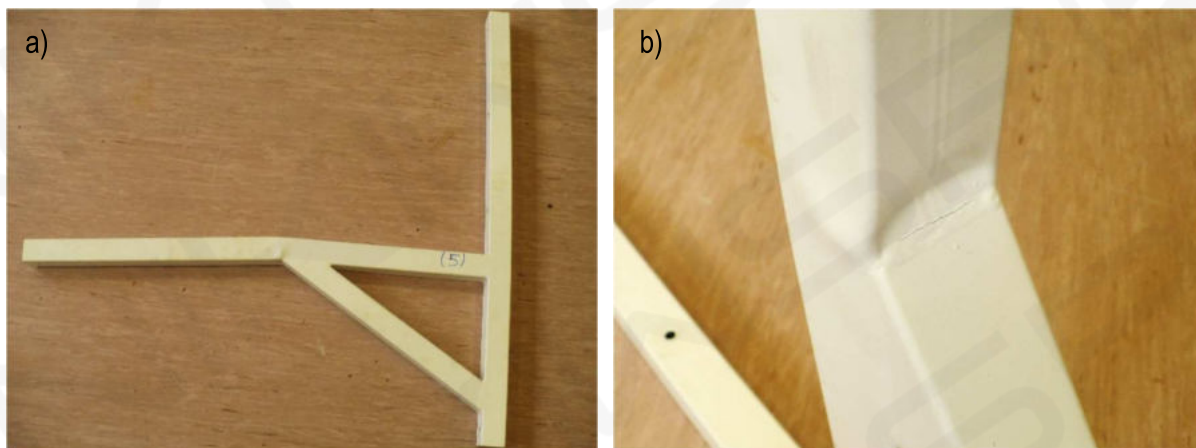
Widok zniszczonego elementu P2: a) widok ogólny, b) miejsce zniszczenia
